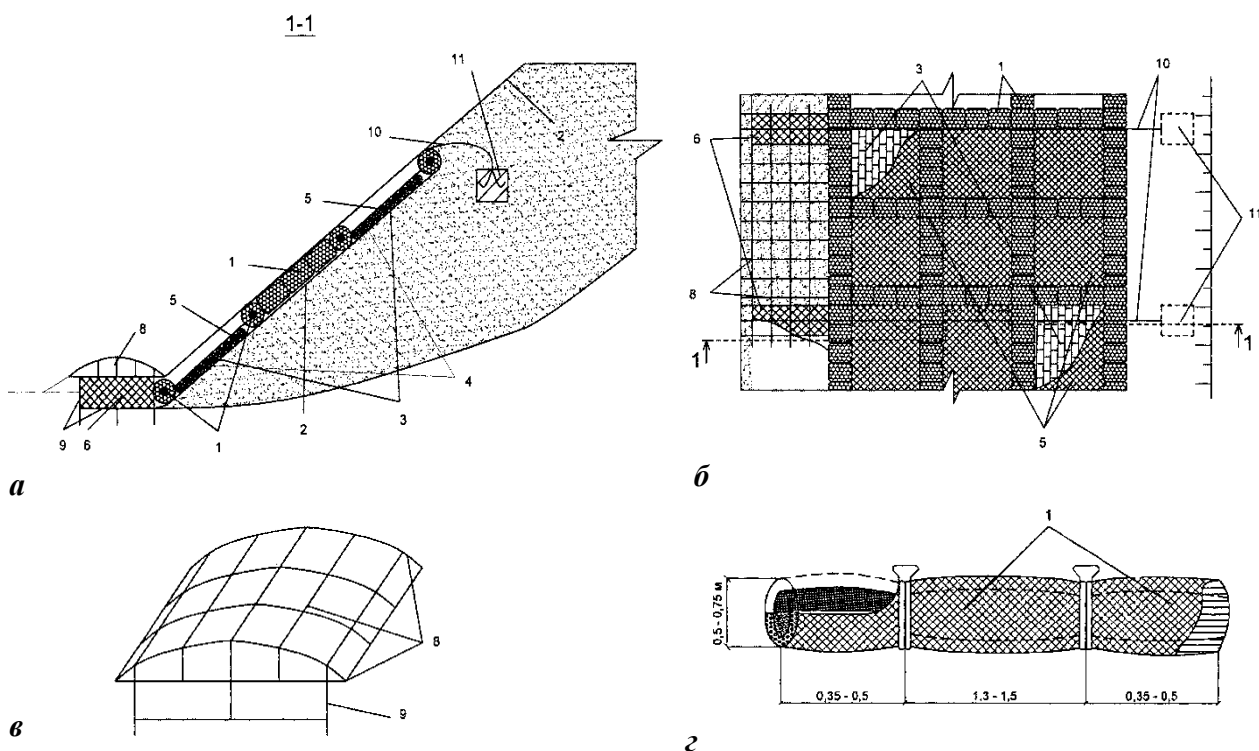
Прибрежное крепление из фашин биопозитивной конструкции
